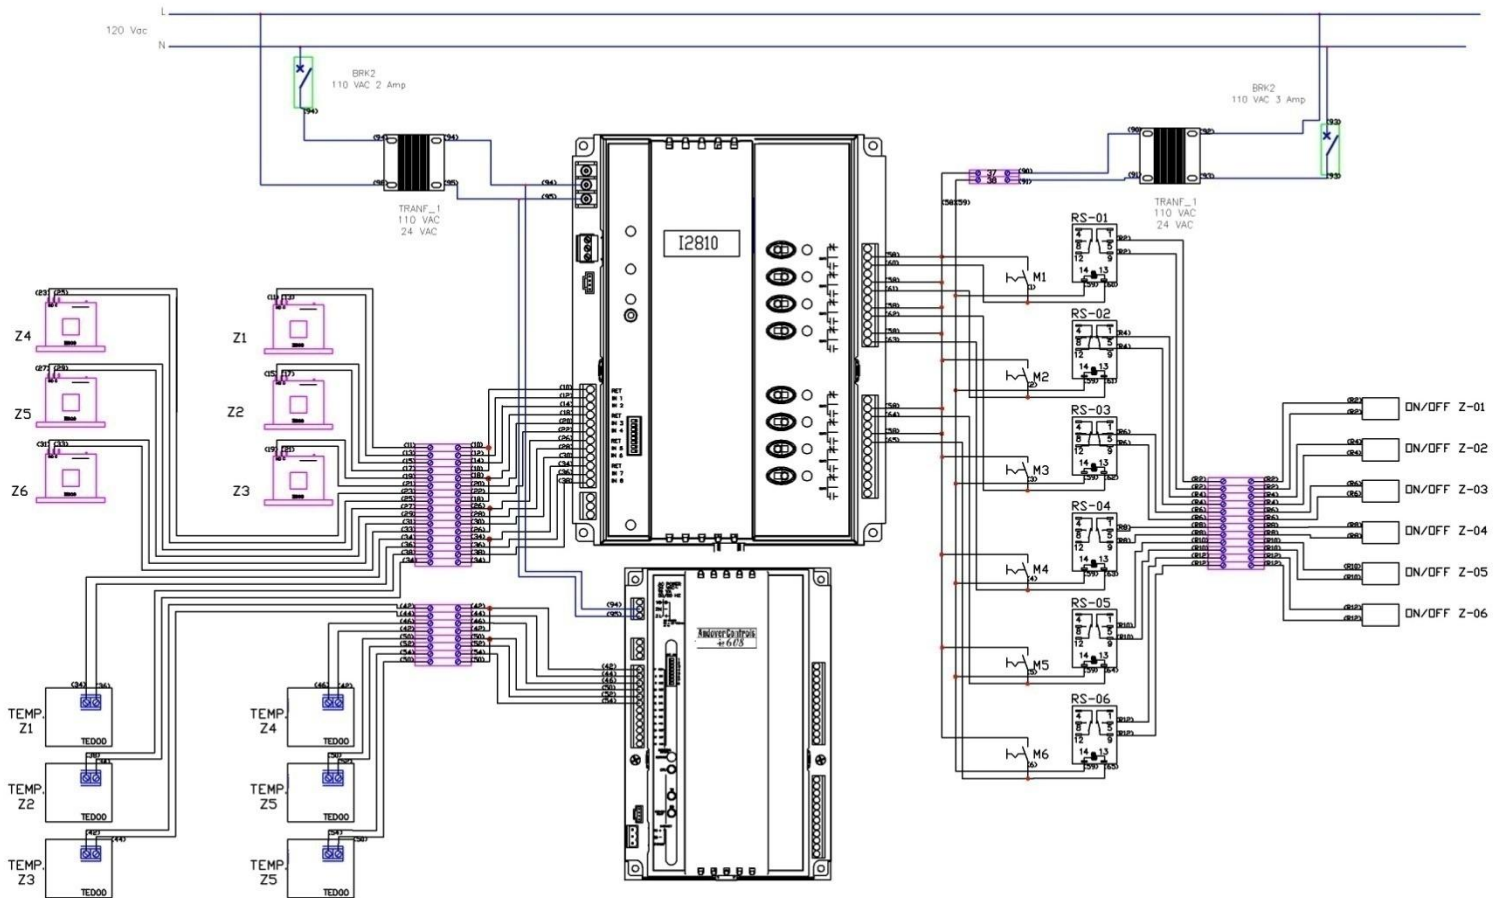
Plano de conexiones electricas Tablero UPB J 4 piso Torre Norte
